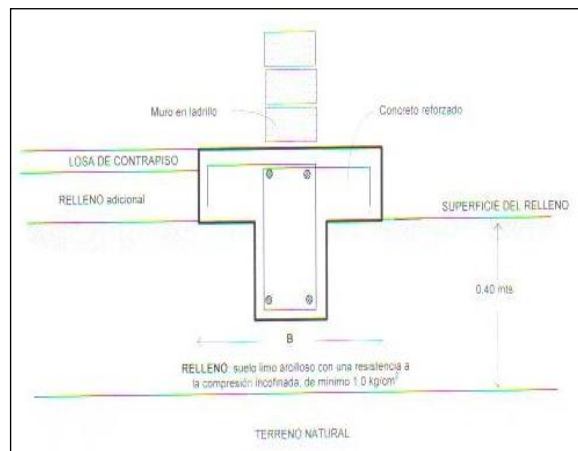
Detalle de zapatas corridas para las viviendas del Conjunto Cerrado Calatrava
